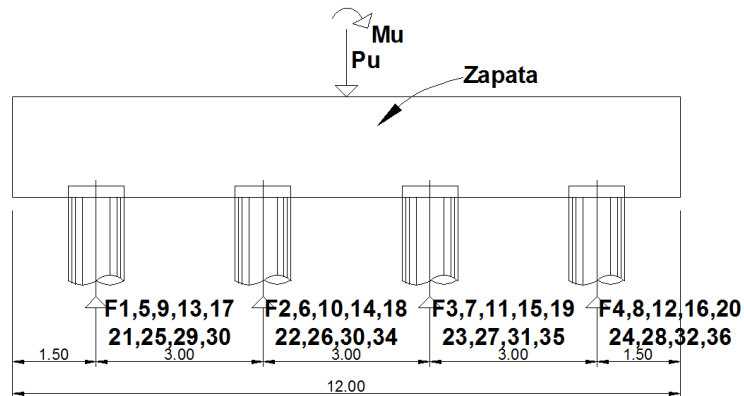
Distribución 2, lateral de los pilotes para la pila P3.
